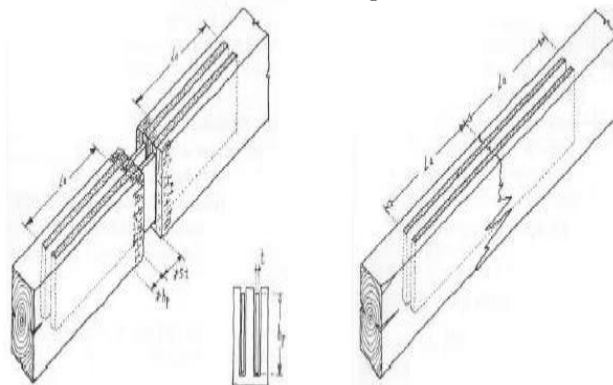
Introdução de placas de FRP ou chapas metálicas seladas com cola epóxi. Fonte: Lopes, 2007.
